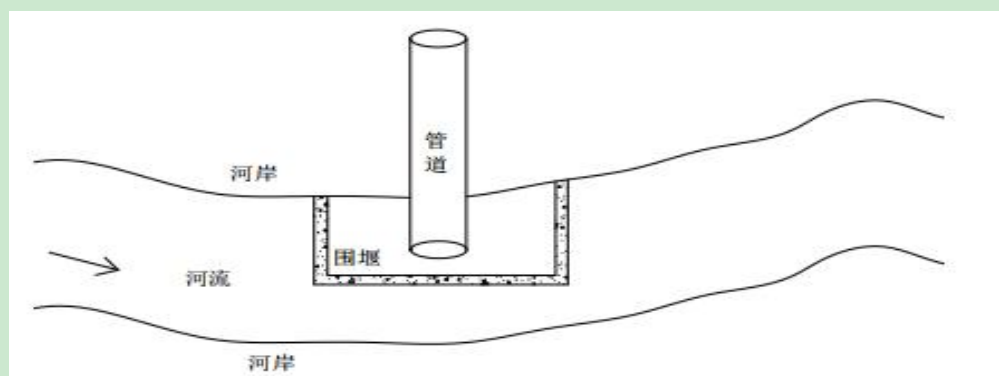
围堰导流开挖管沟法施工断面示意图
